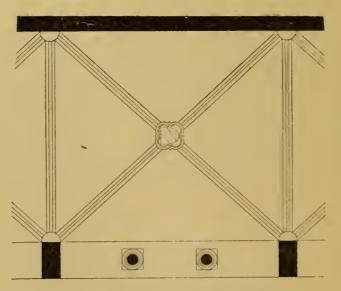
Grundriss eines Kreuzgangjoches. (Massstab 1:60.)
